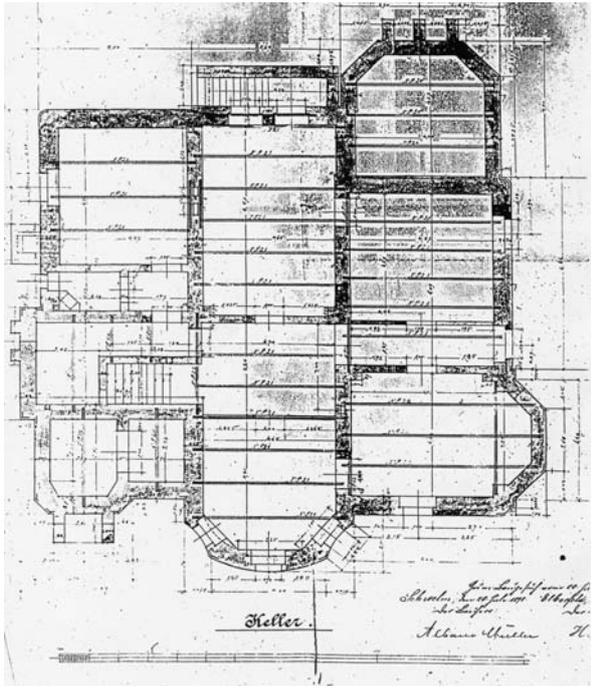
H. Plange, Villa Albano Müller, Grundriss Kellergeschoss, 1898
